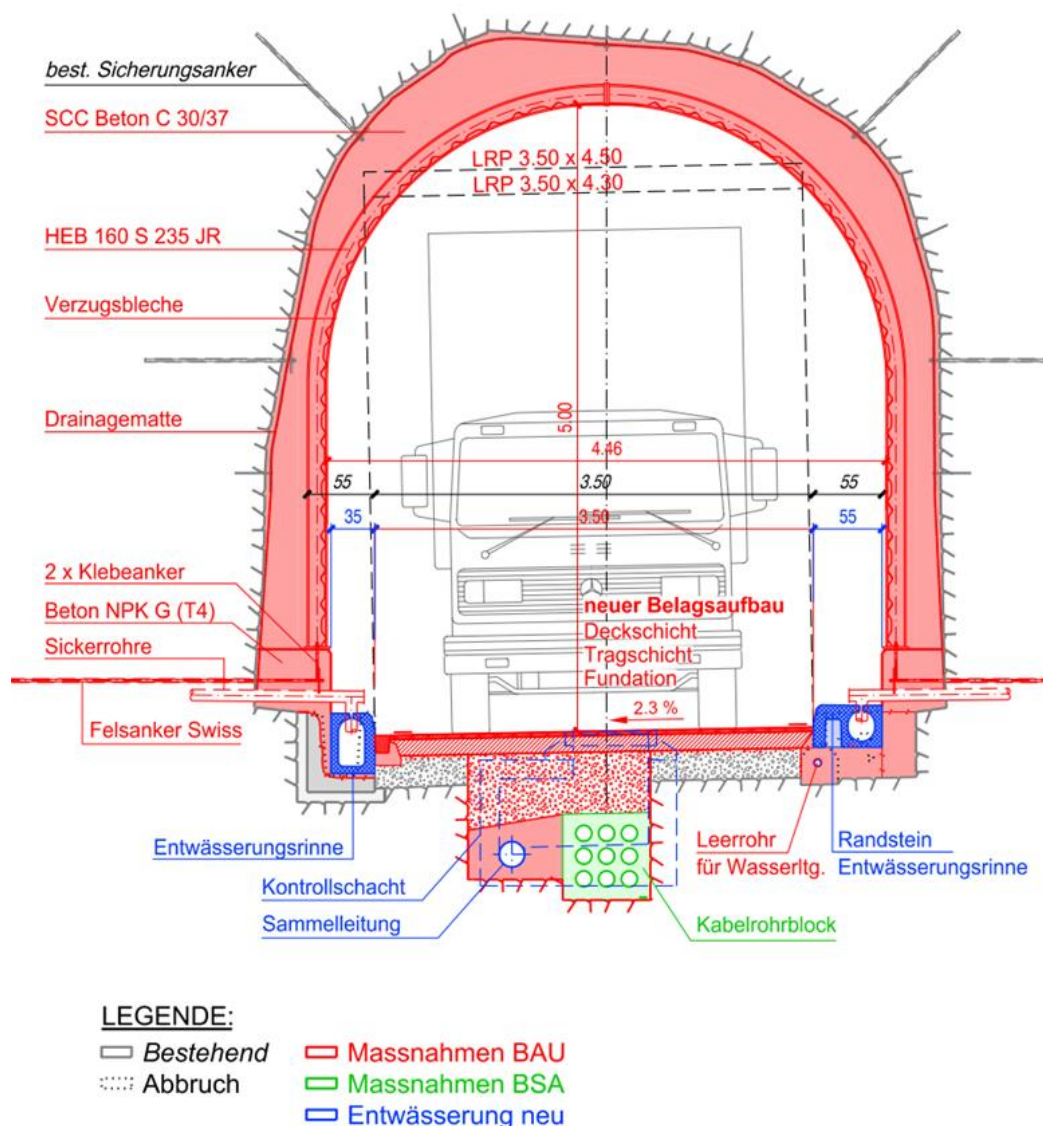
Querschnitt im Bereich B mit Vollausbau mit Stahlbögen und hinterbetonierten Verzugsblechen
